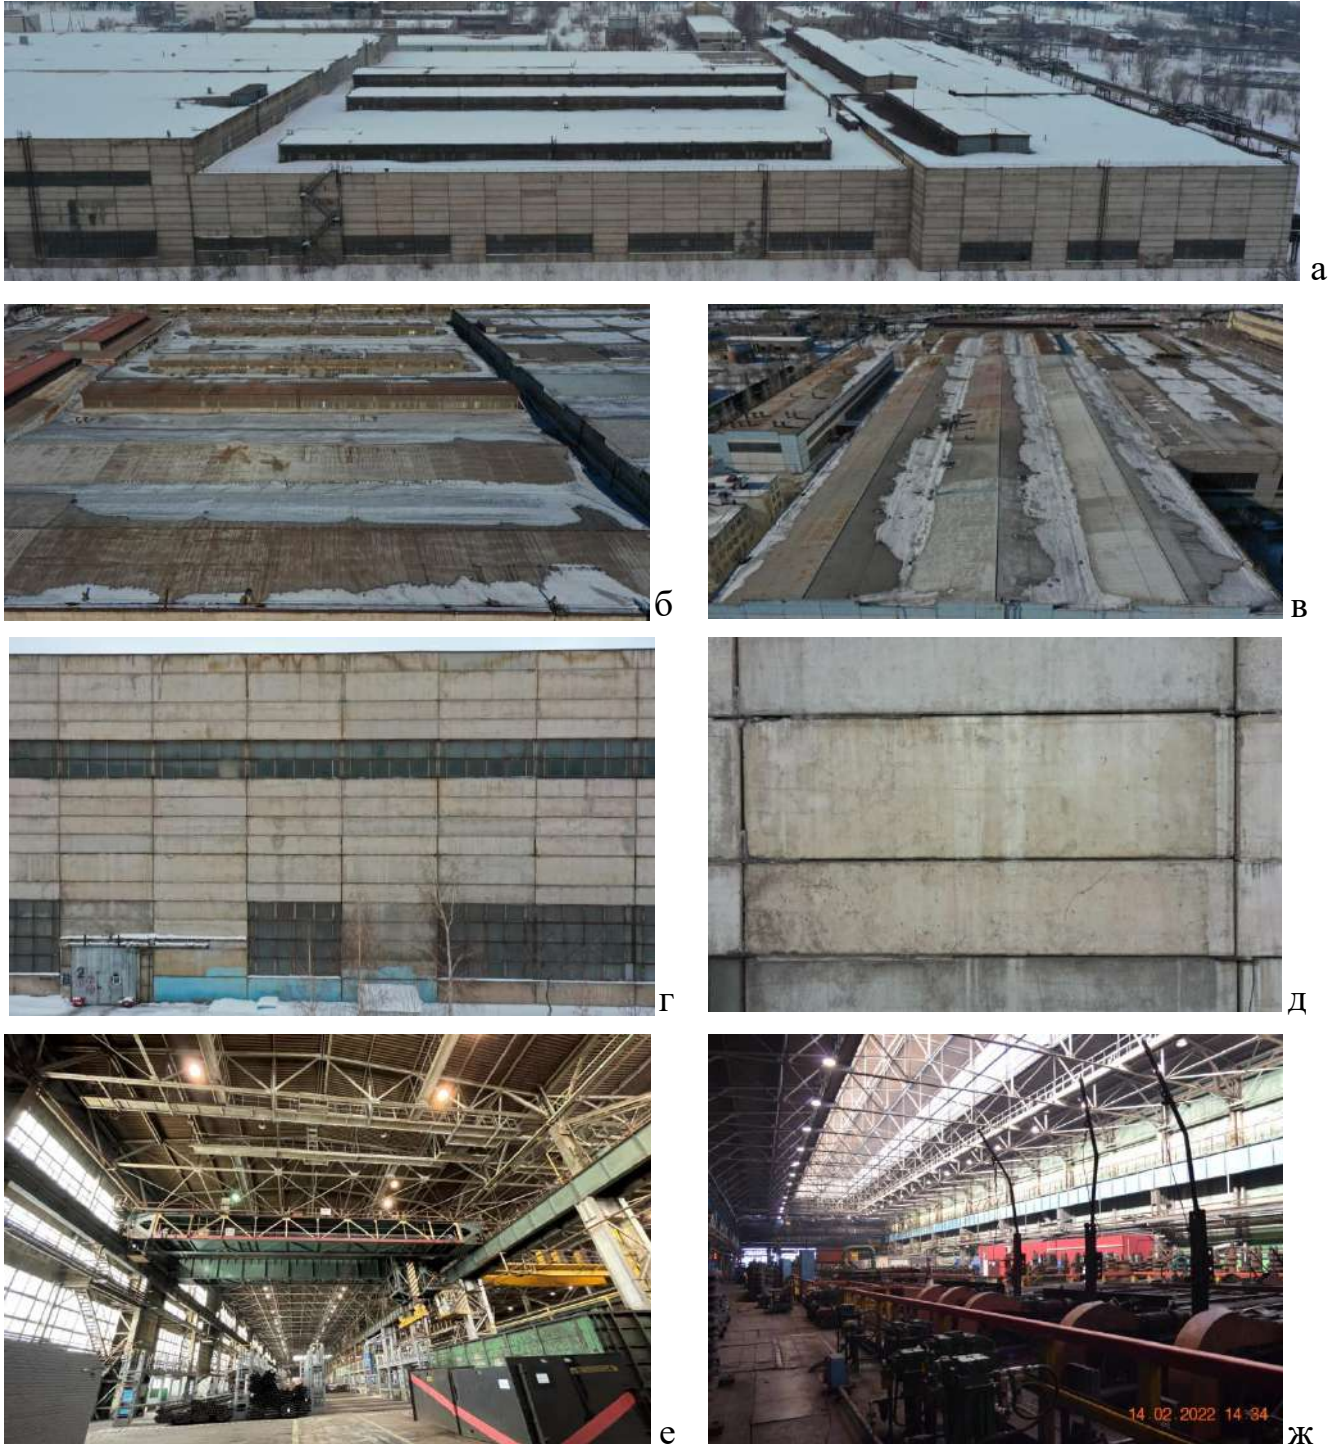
Вид главного корпуса листопркатного цеха № 8 ПАО «ММК»: а – общий вид здания; б, в – фрагменты кровли здания; г, д – фрагменты фасада здания; е, ж – вид производственных помещений внутри здания
